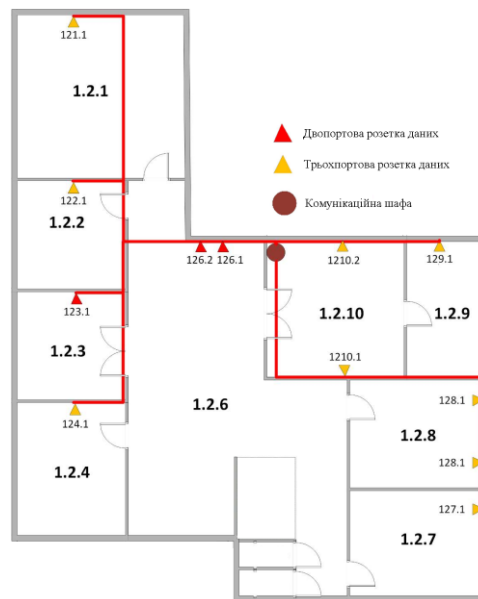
План прокладки кабельних трас на другому поверсі
